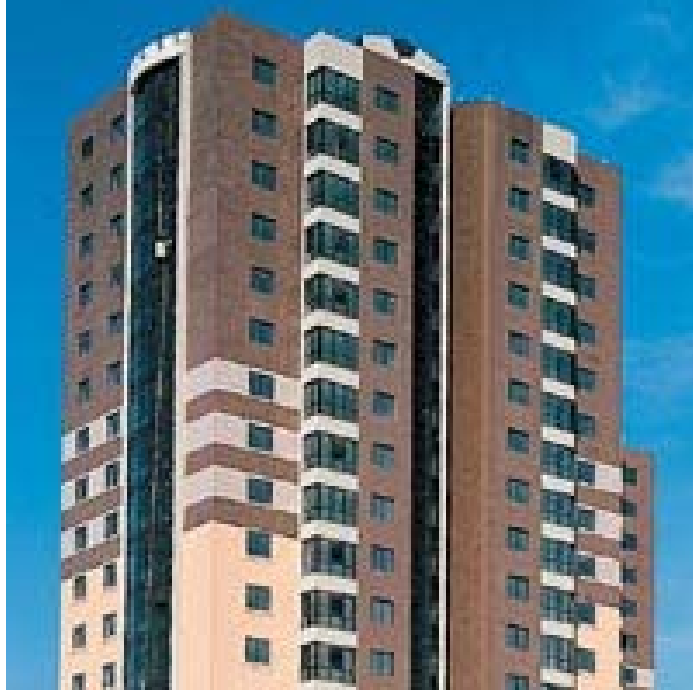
Gazbeton Panolar (www.akg-gazbeton.com.tr).
